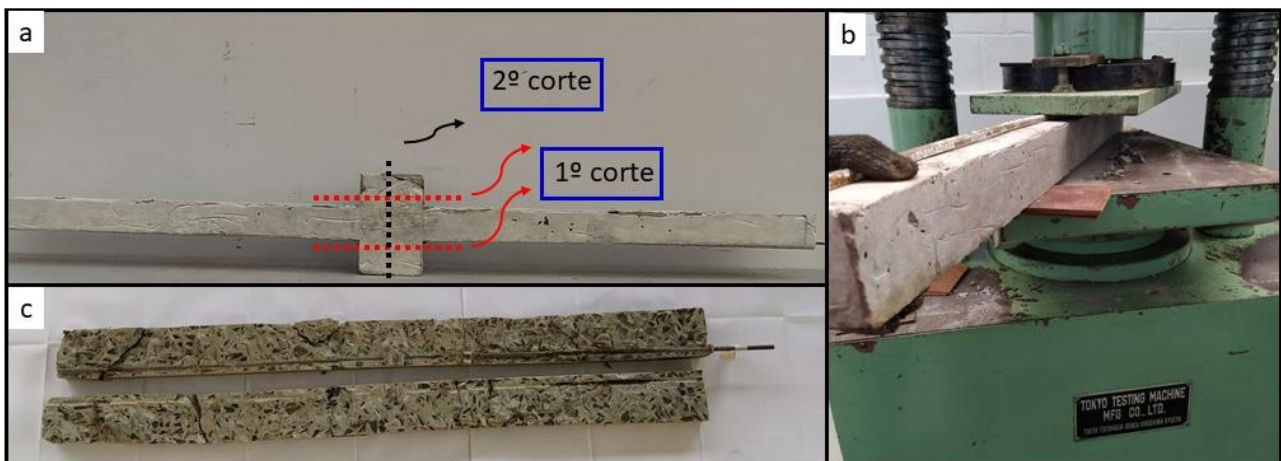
Abertura das vigas para retirada das amostras de aço e concreto, sendo: a) pontos de corte da viga; b) abertura das vigas na prensa hidráulica; c) viga aberta.
